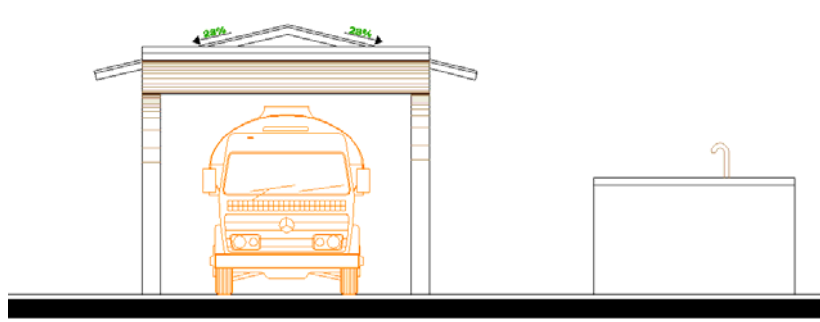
Vista lateral derecha de la planta de reciclaje, zona de maniobras
